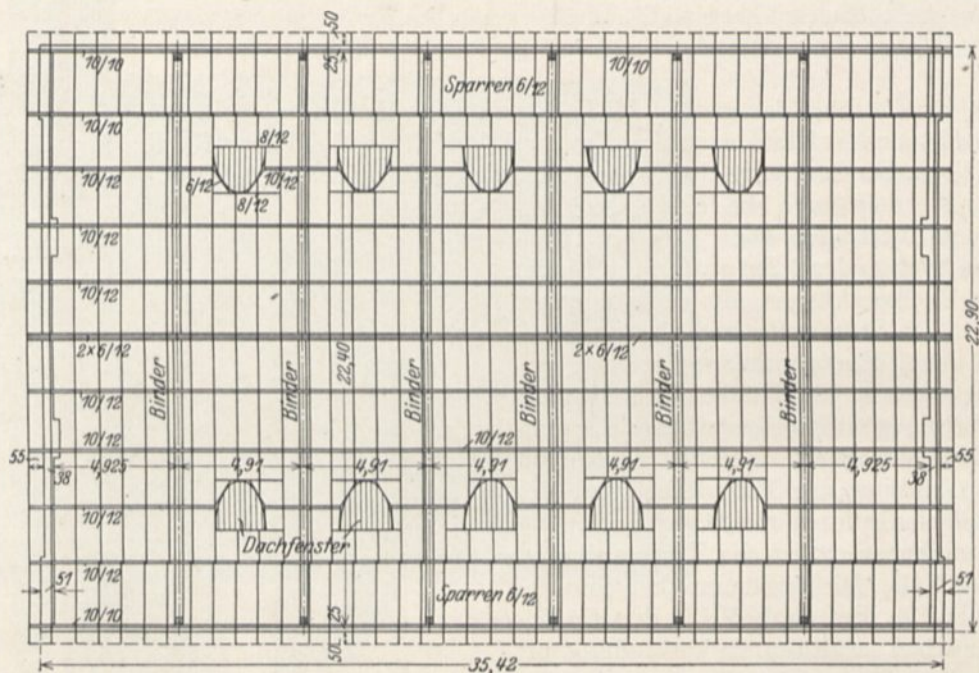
Allgäuer Tierzuchtthalle Kempten. Grundriß mit Pfetten- und Sparrenplan. (Ausführung: Karl Kübler A.-G., Stuttgart.)
